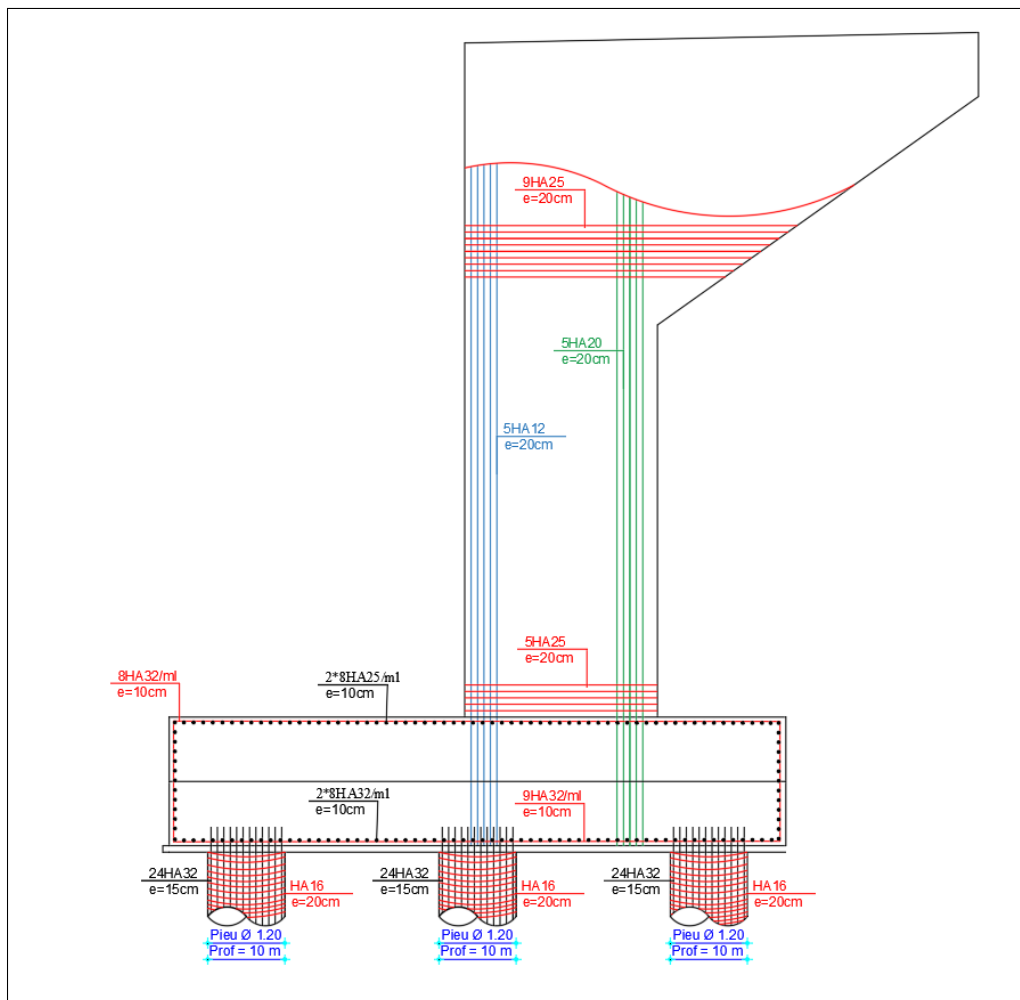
PLAN FERRAILLAGE MUR EN RETOUR, SEMELLE ET PIEUX.
